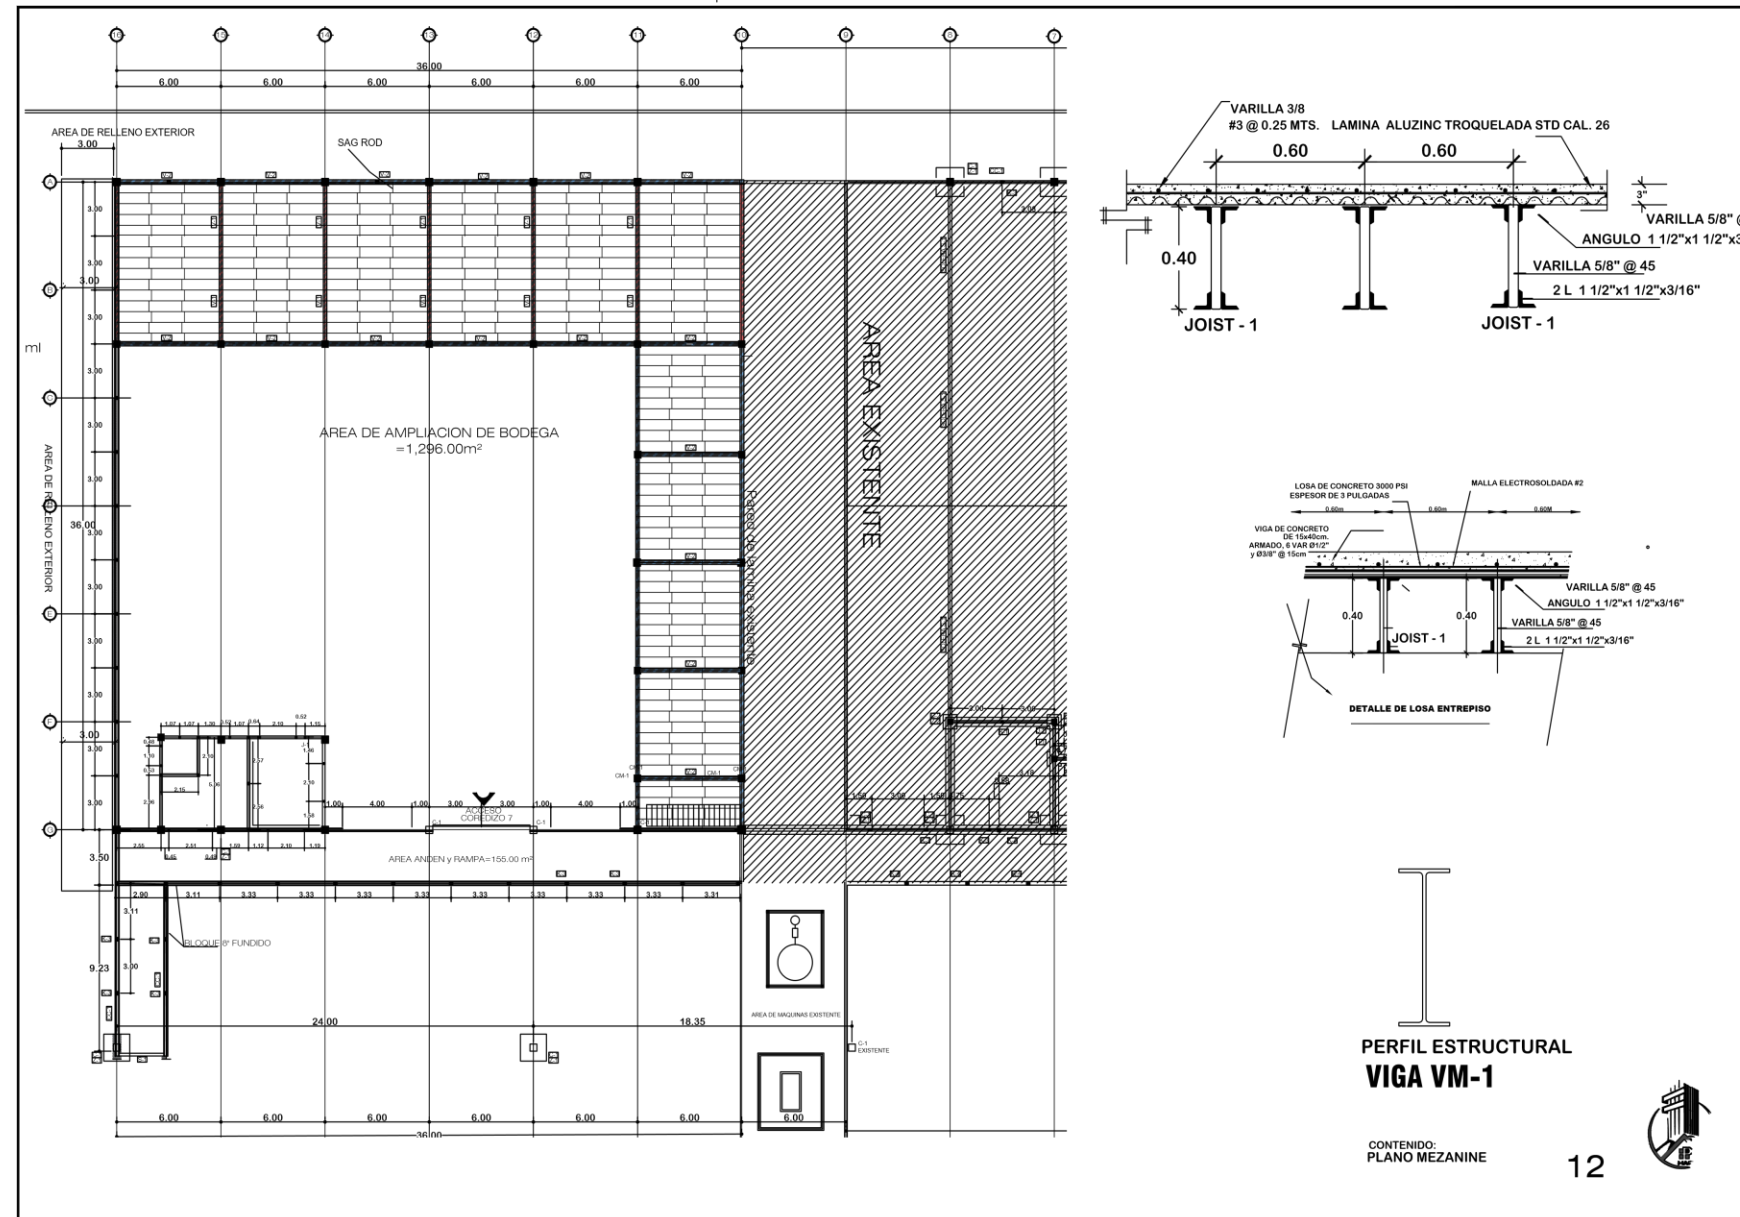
Plano de losa de entrepiso en Mezzanine de CORIPSA
